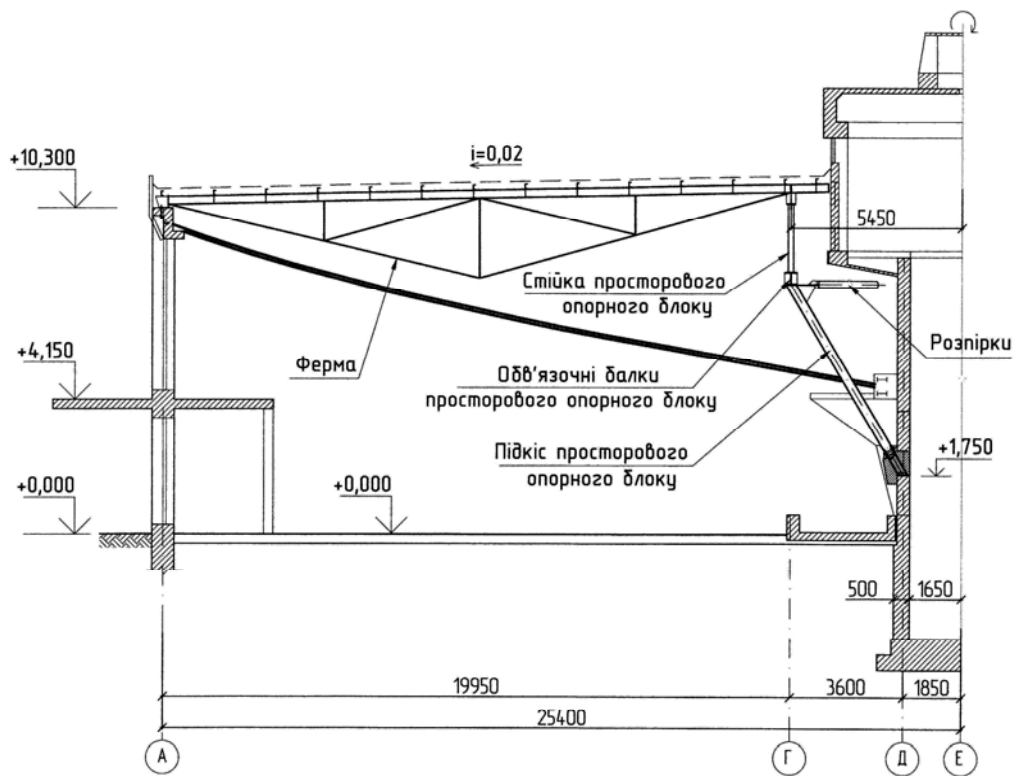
Поперечний переріз будівлі біовету з новою конструкцією покриття
